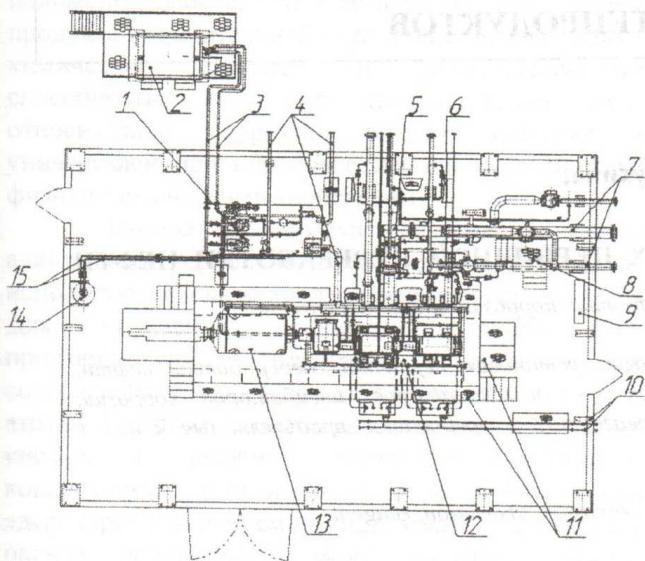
Установка компрессорная центробежная 32ГЦ-115/2-38 К.У1
